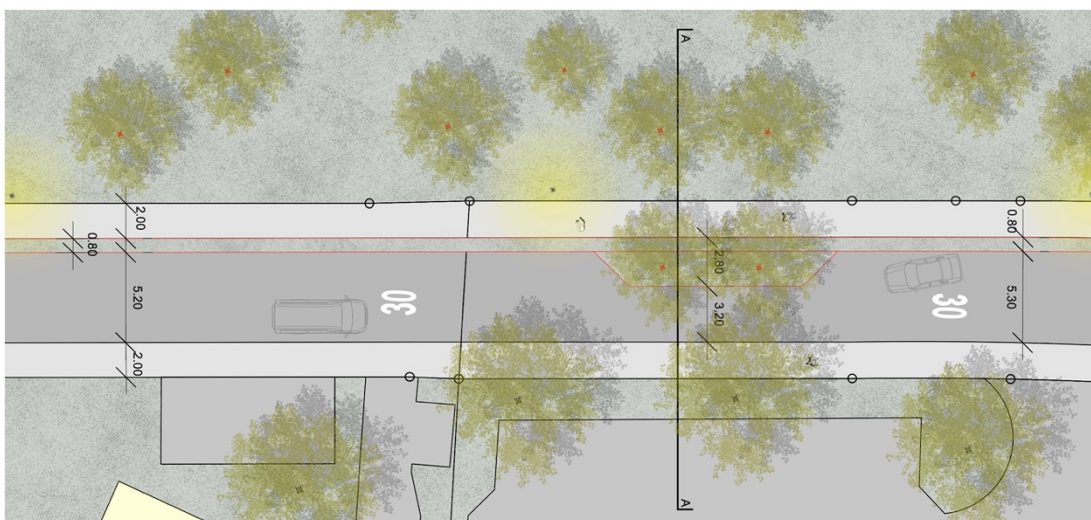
Detailausschnitt Situation Grabenackerstrasse
